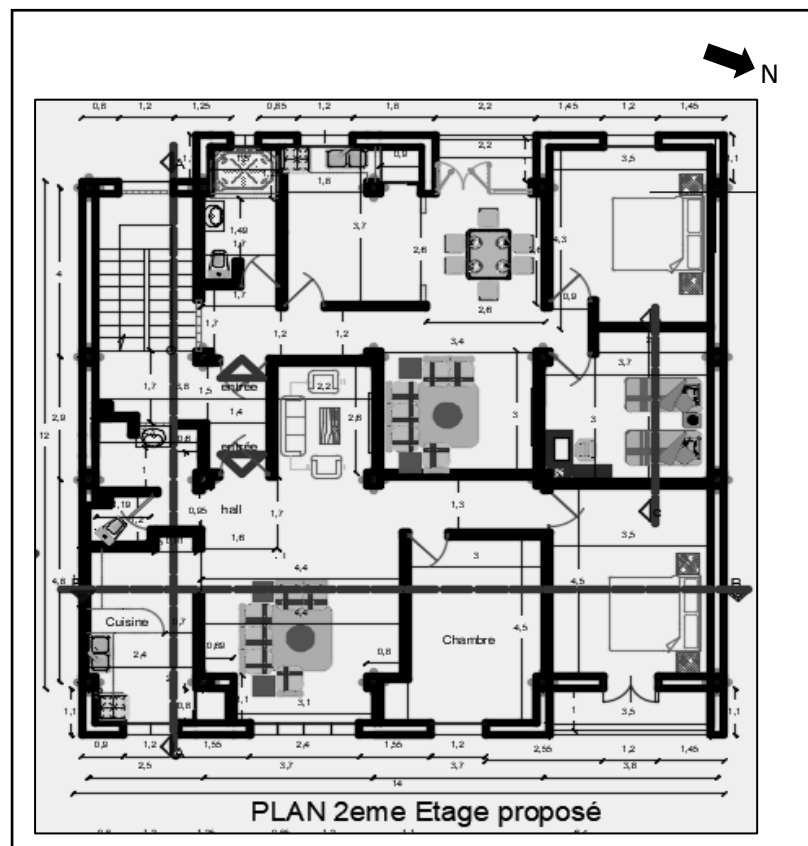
plan 2ém étage ech 03 (source: propriétaire)
